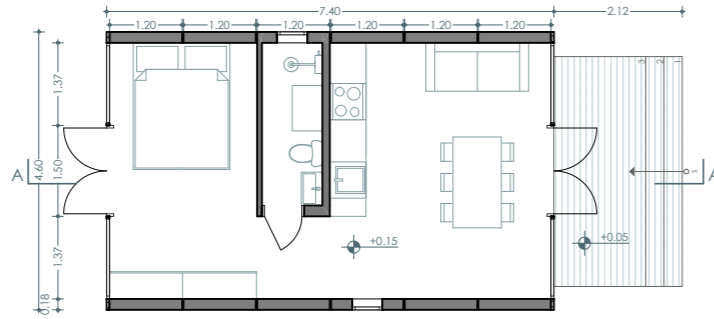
Planta tipo Wikkelhouse. Fuente: Autores, 2023
